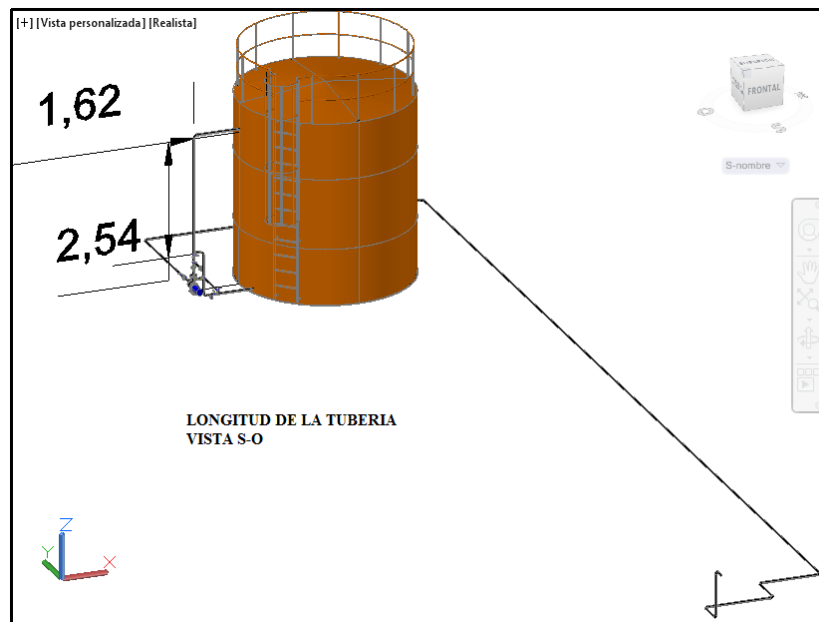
55 – Plano de longitud de tubería – Vista S-O.
